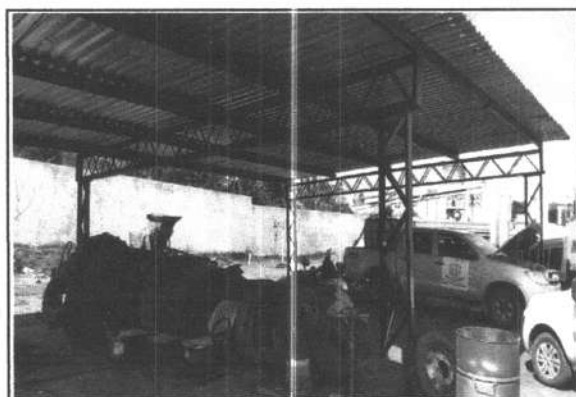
GALPÃO EXISTENTE GARAGEM PARA DESMONTAR
